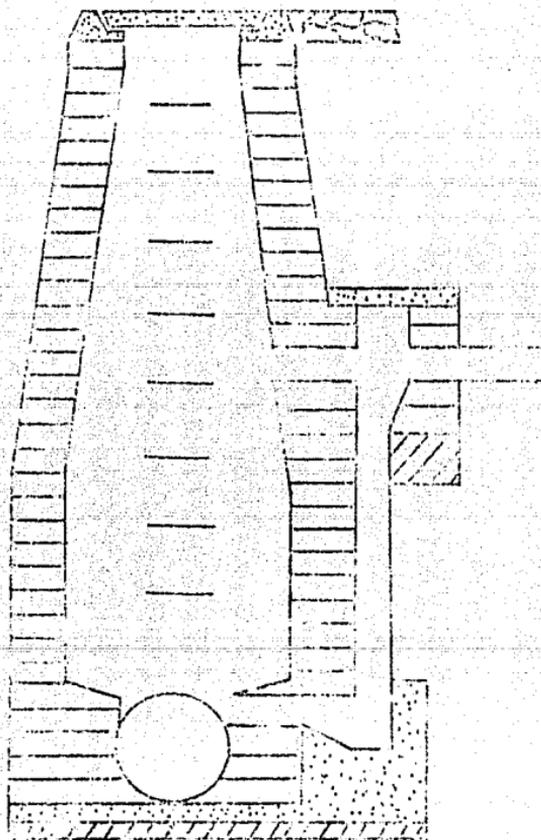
(a) Pozo con caída adosada hasta de 2m, para tuberías de 20 a 25 cm de diámetro
